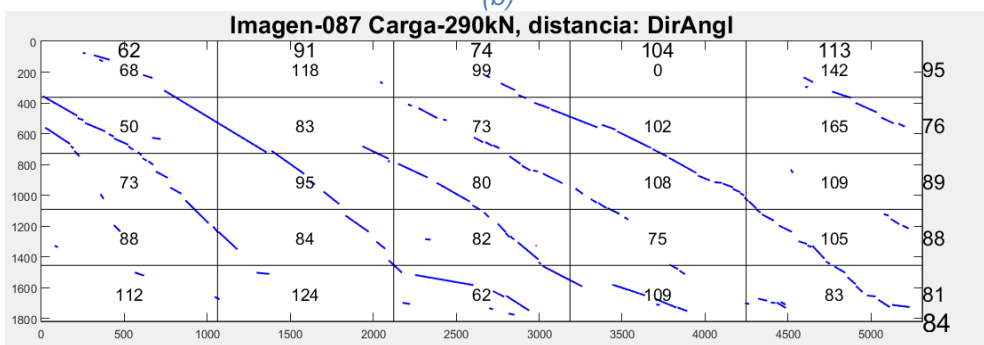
Patrón de Fisuras Viga I121I-Ciclo 3.
